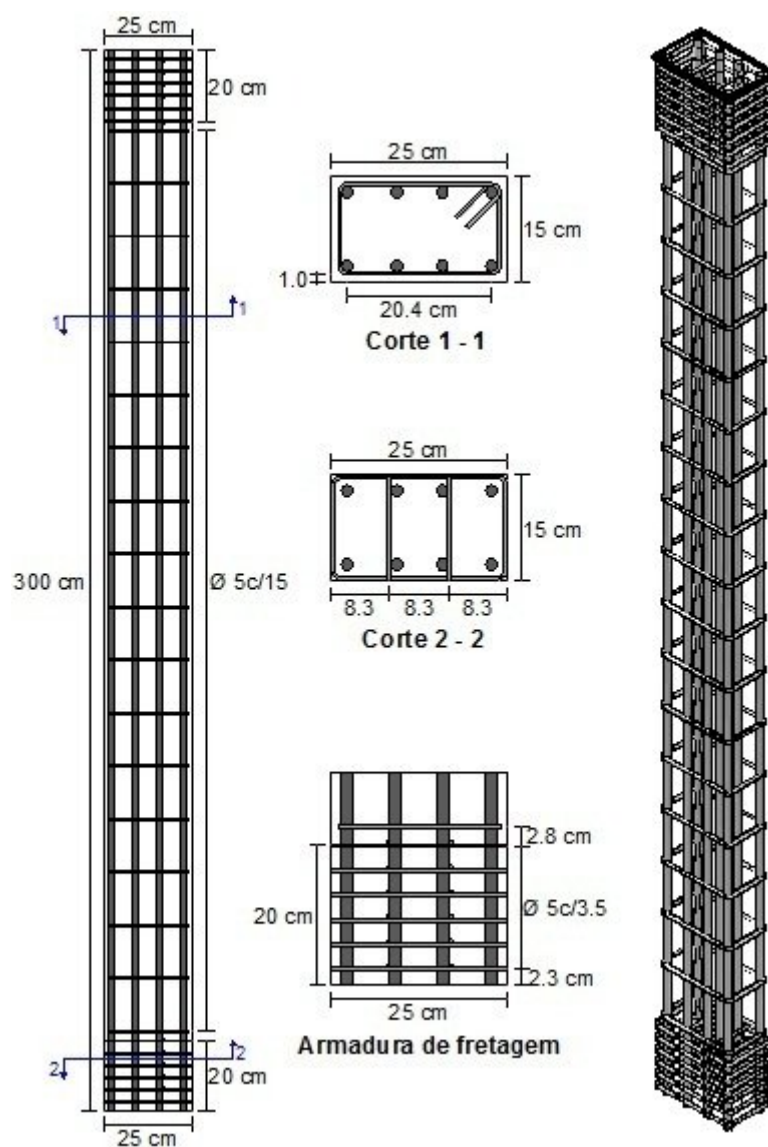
Detalhamento das armaduras dos pilares C40-4.3 e C80-4.3
